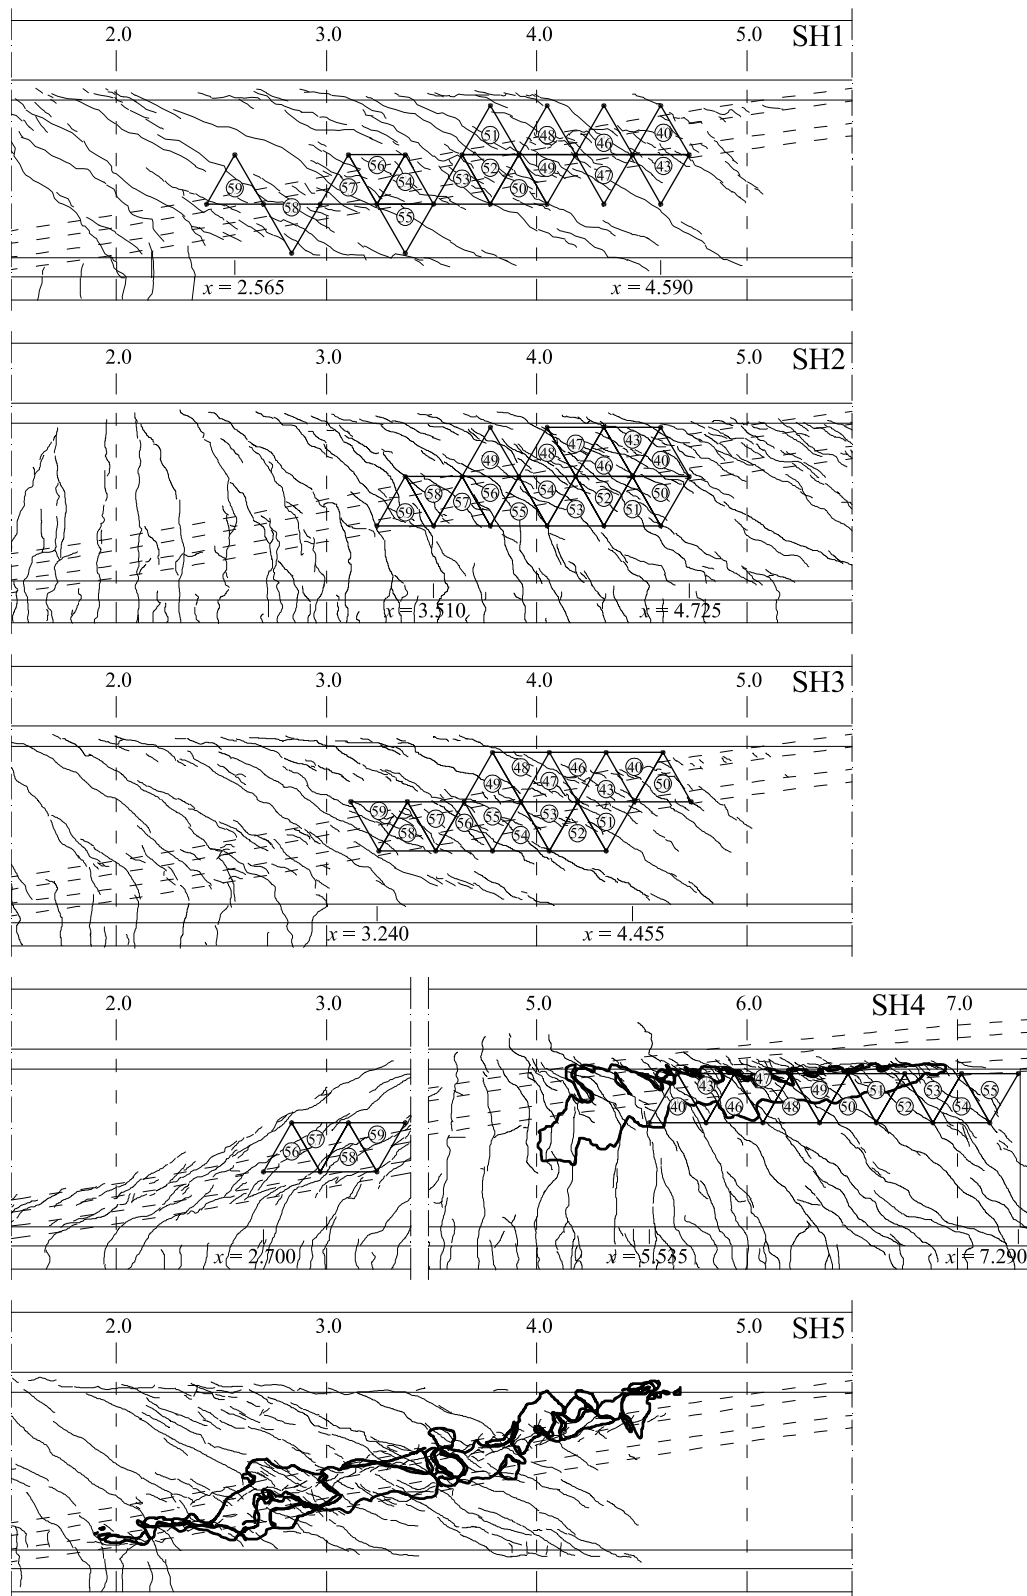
Poutres SH1 à SH5, partie Sud : fissuration et éclatement du béton lors de la rupture ; emplacement des capteurs dans la zone susceptible de rupture mesurant l'allongement local du béton de l'âme et la fissuration interne dans le plan de l'âme
